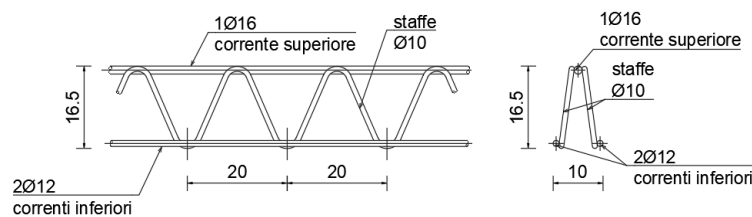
Sezione tipologica traliccio tipo Pittini
